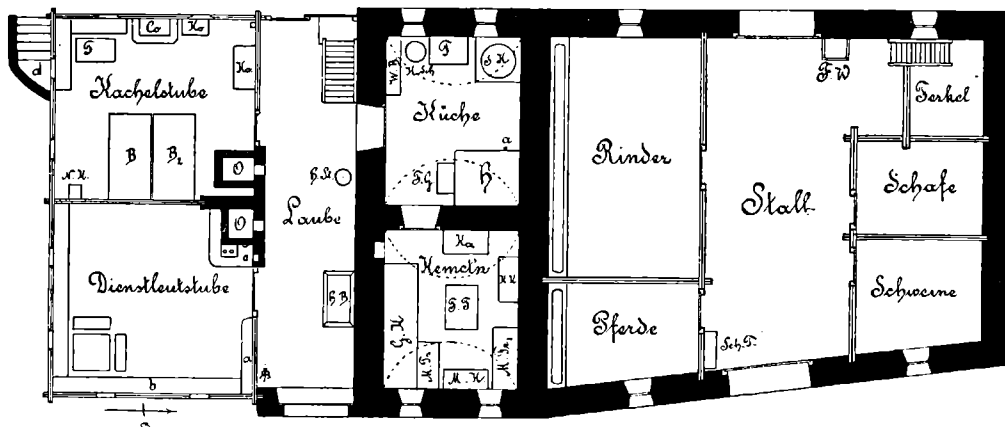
Grundriss des Erdgeschosses des Schmied-Hauses.
